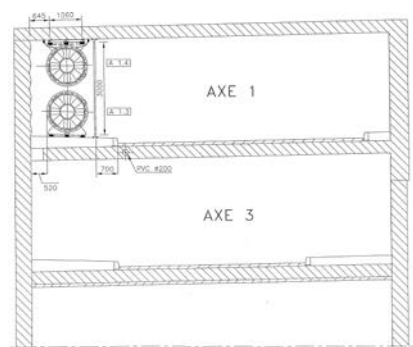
Profil en travers type des accès au tunnel Ouest -> Est
